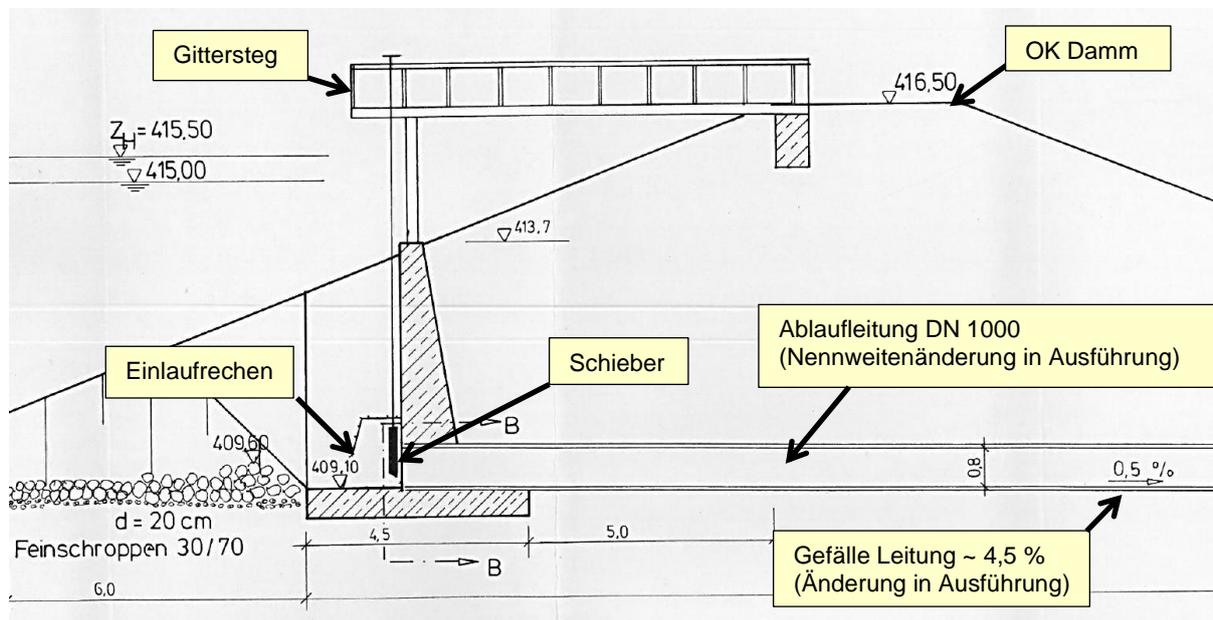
Schnitt durch Einlaufbauwerk – Plan Entwurf 1996
